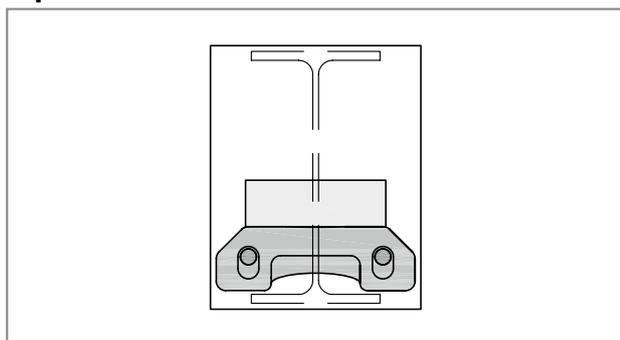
Schöck Isokorb® T type SQ : le taquet fourni par le maître d'ouvrage se trouve directement sur la plaque d'absorption de la charge
